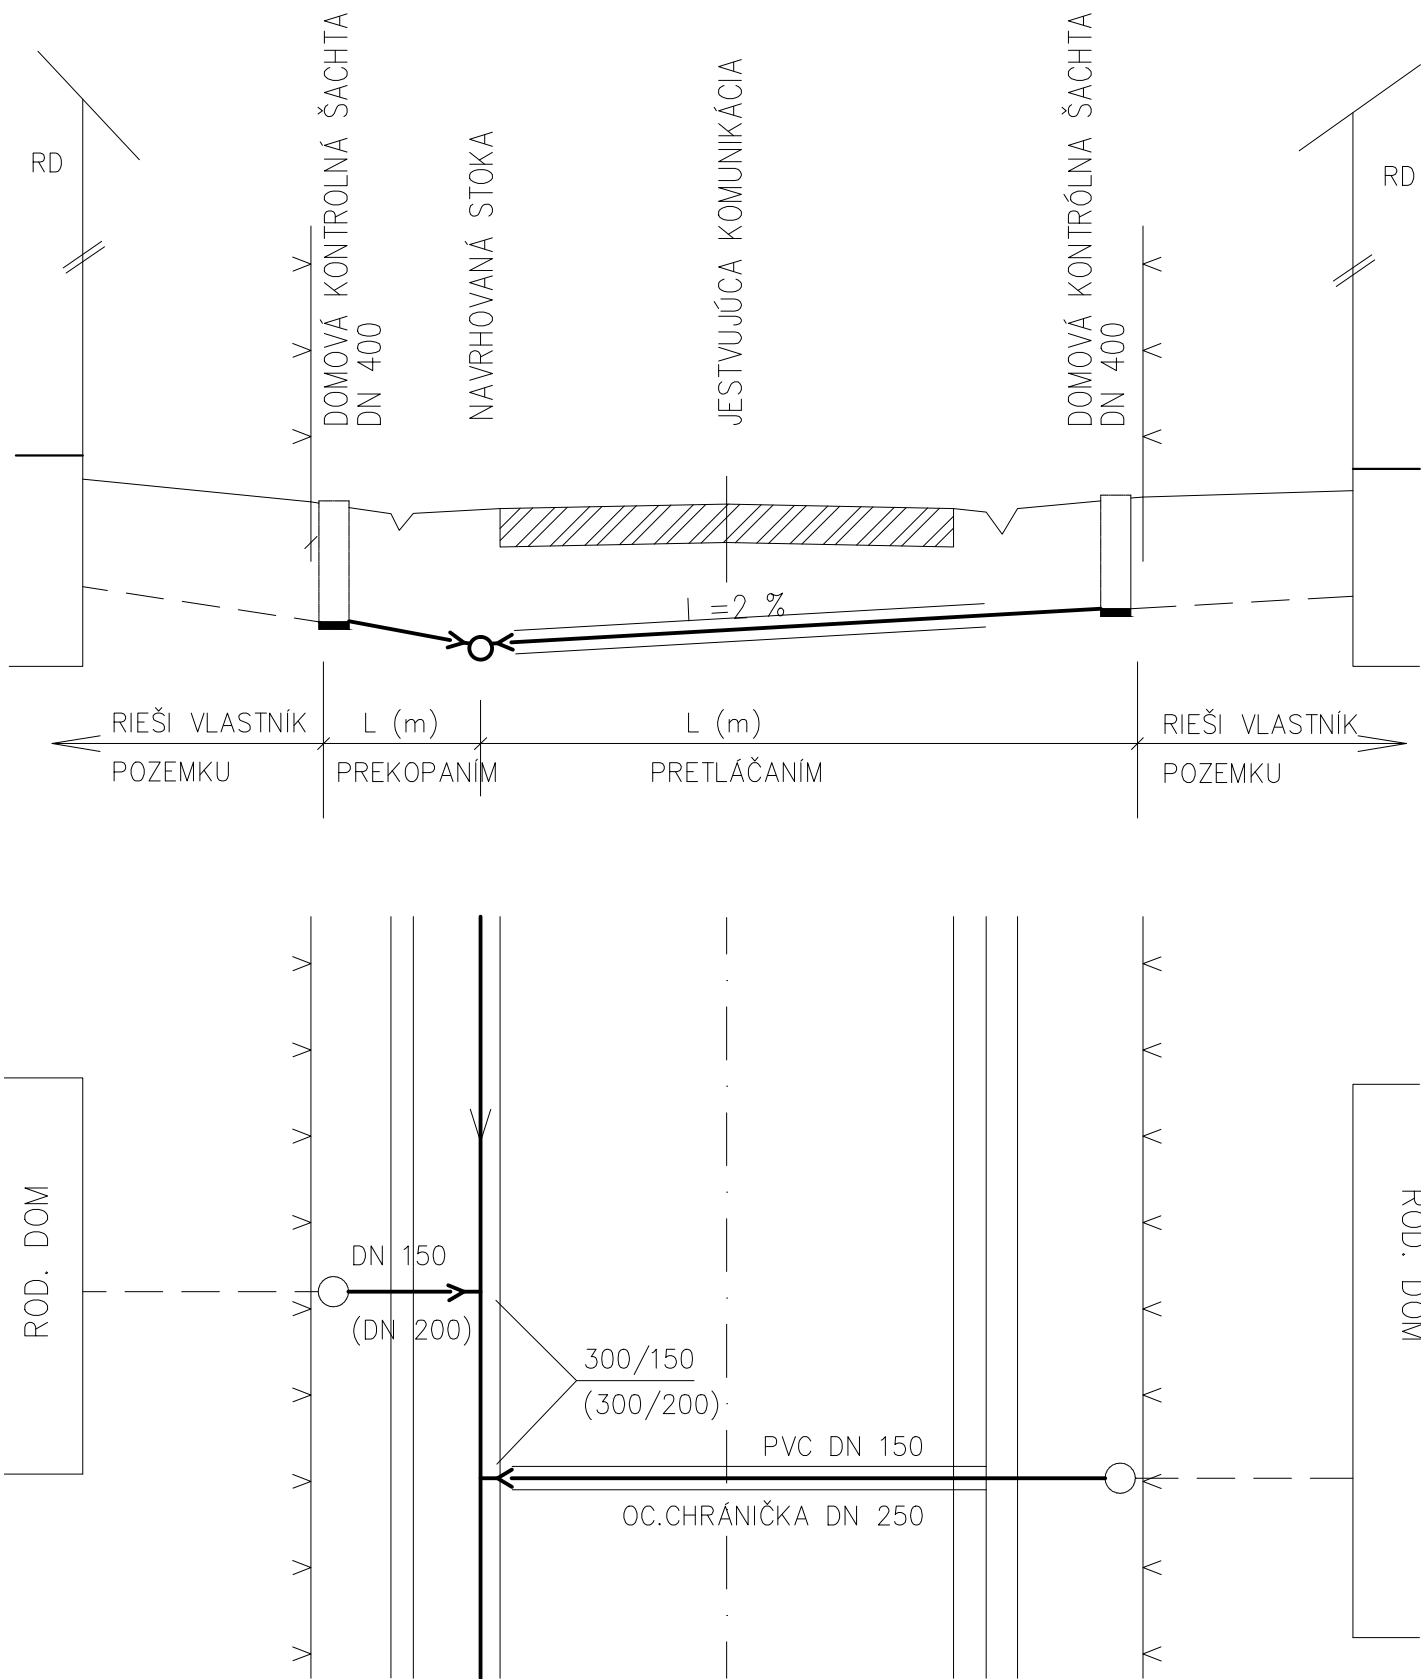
DETAIL NAPOJENIA PRÍPOJKY NA PVC POTRUBIE
